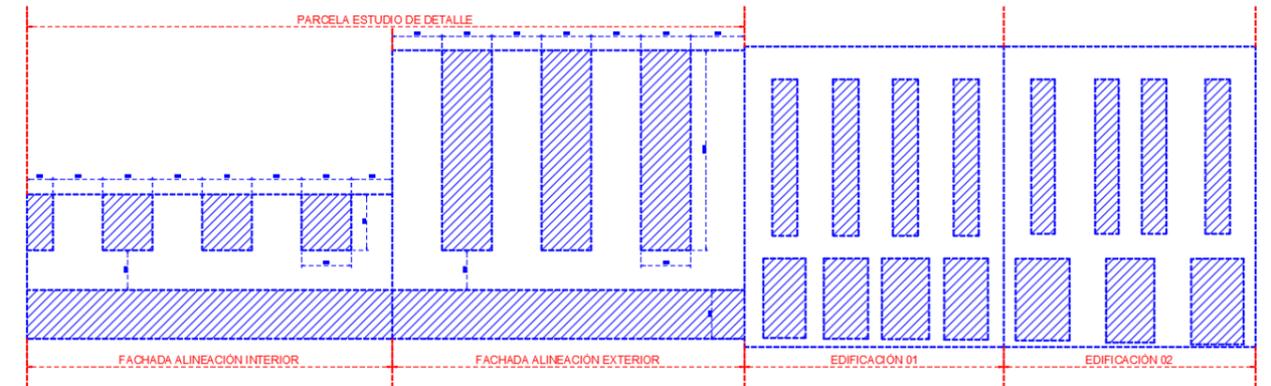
Geometrización del alzado de la calle Antonio Domínguez Alfonso
